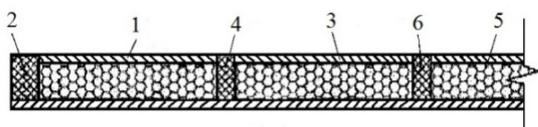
Схема бетонирования верхней части перекрытия: 1–6 – порядок бетонирования
